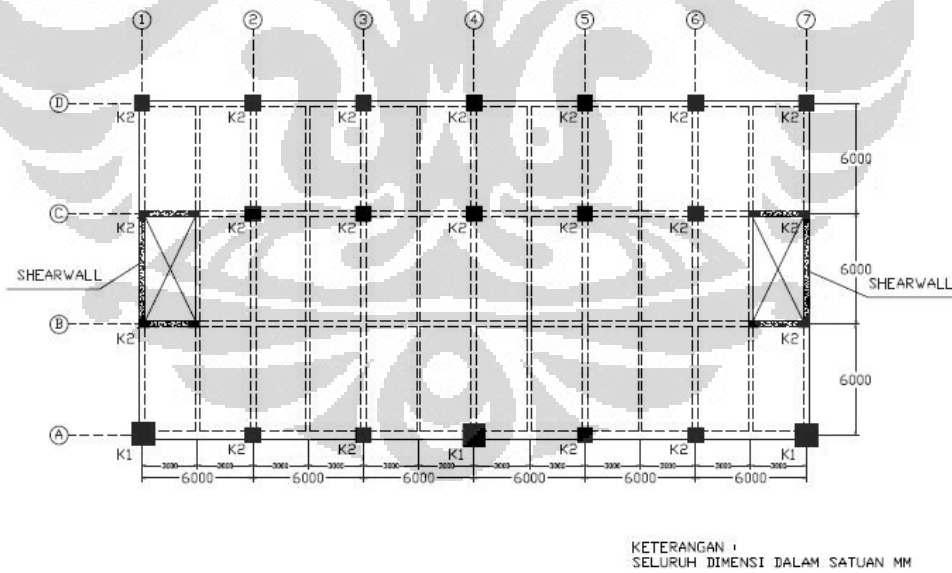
Denah Struktur Bangunan Lantai 1 – Lantai 2
